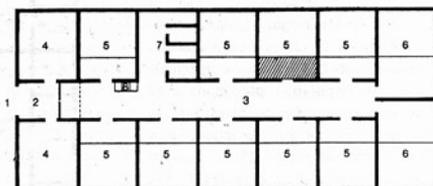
Planta arquitectónica de vecindad. 1. Calle, 2. Zaguán, 3. Patio, 4. Viviendas a la calle, 5. Viviendas menores, 6. Viviendas mayores, 7. Baños colectivos, 8. Lavaderos.
